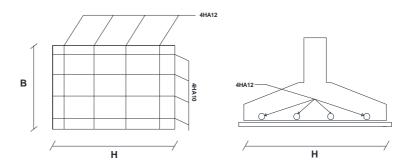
Schéma de ferraillage de la semelle de potelet.
